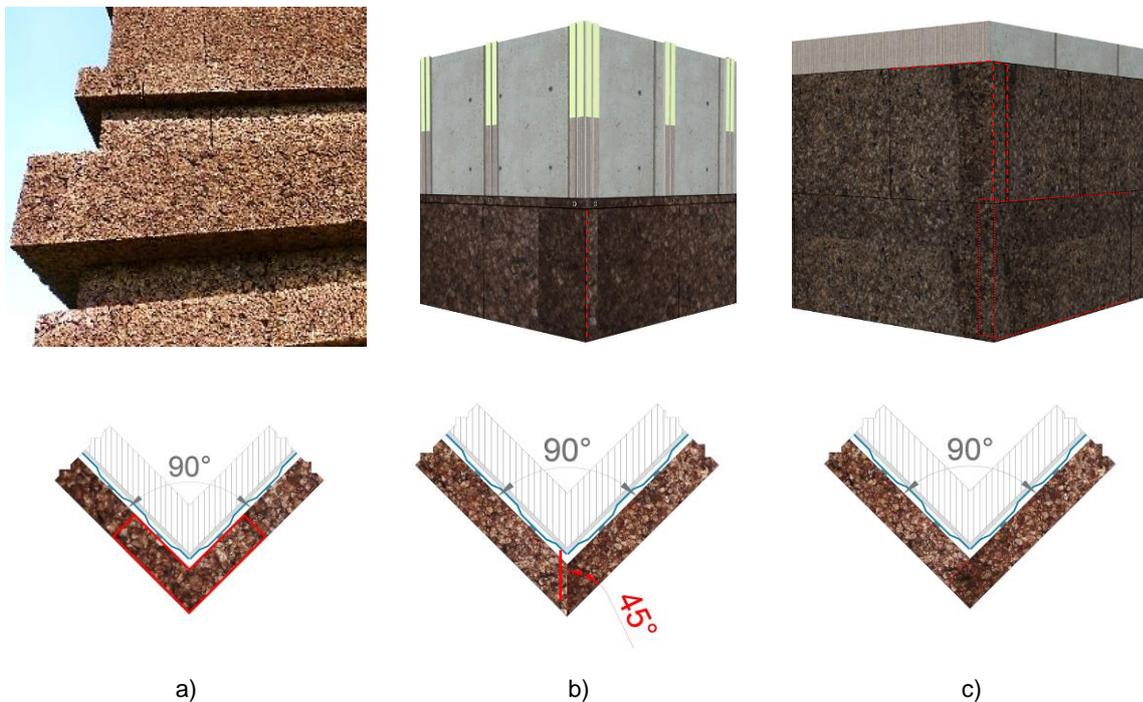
Raccords d'angle: a) ICB spécial d'angle en une pièce; b) ICB en demi-plaques de recouvrement coupées à 45° et c) ICB décalé
